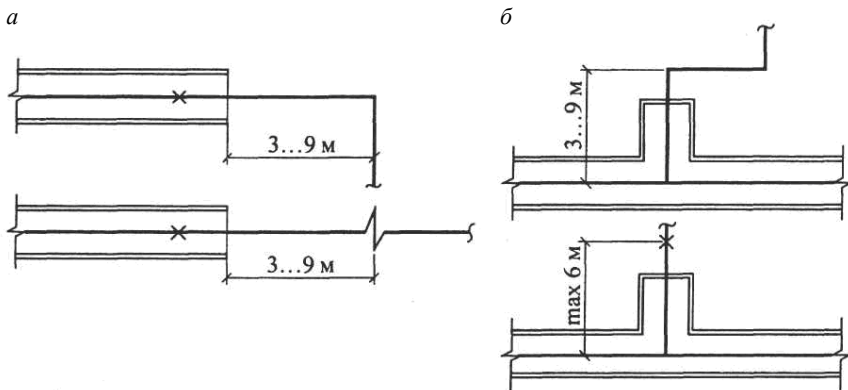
Соединение бесканальной прокладки трубопровода с канальной:
